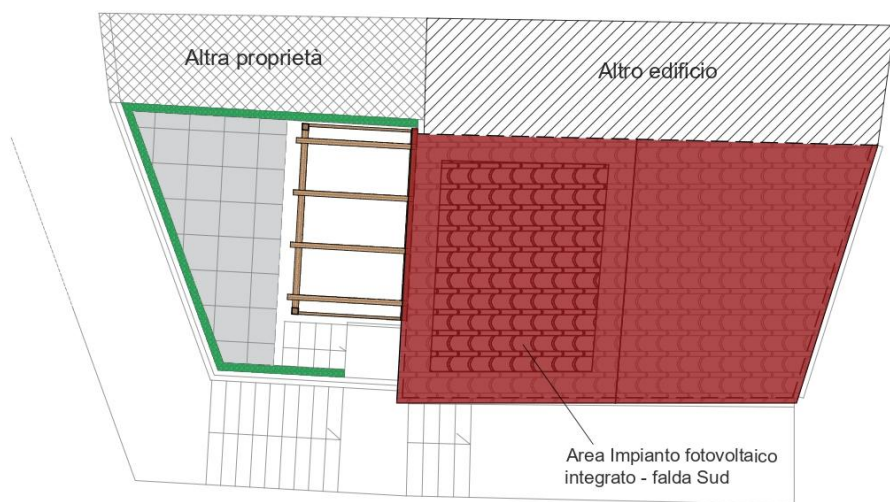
IP - Pianta piano Primo e Copertura
